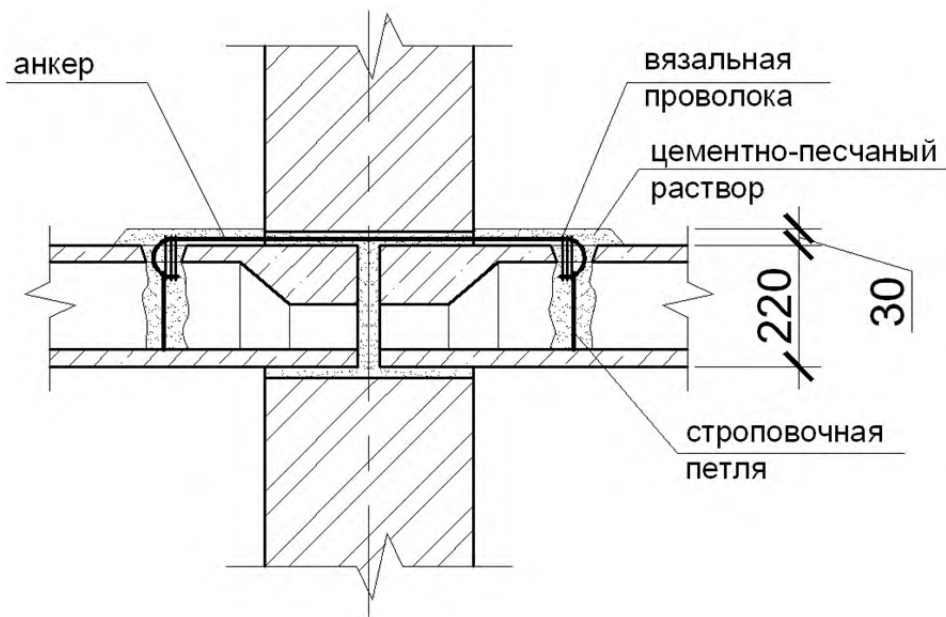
Узел опирания плит перекрытий на внутреннюю стену крупнопанельного дома
